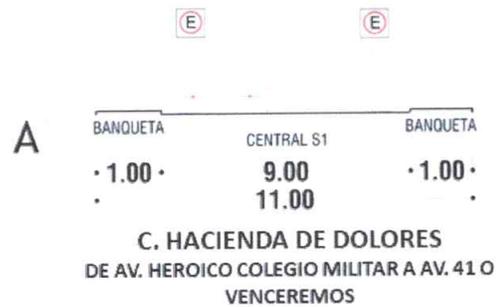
Sección vial de 11.00 metros e imagen de la Calle Hacienda de Dolores.
